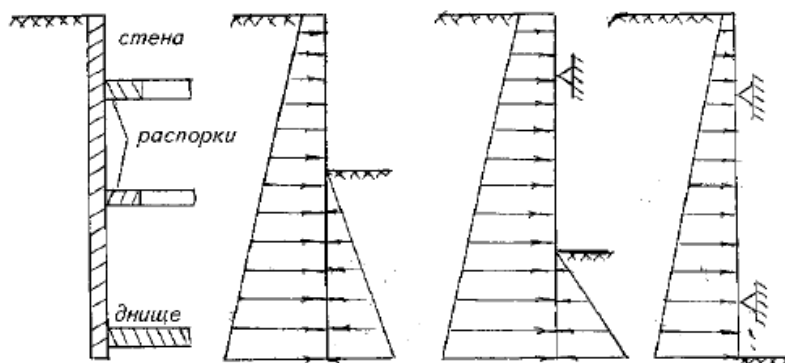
Расчетная схема сооружения со стенами с промежуточными опорами.
